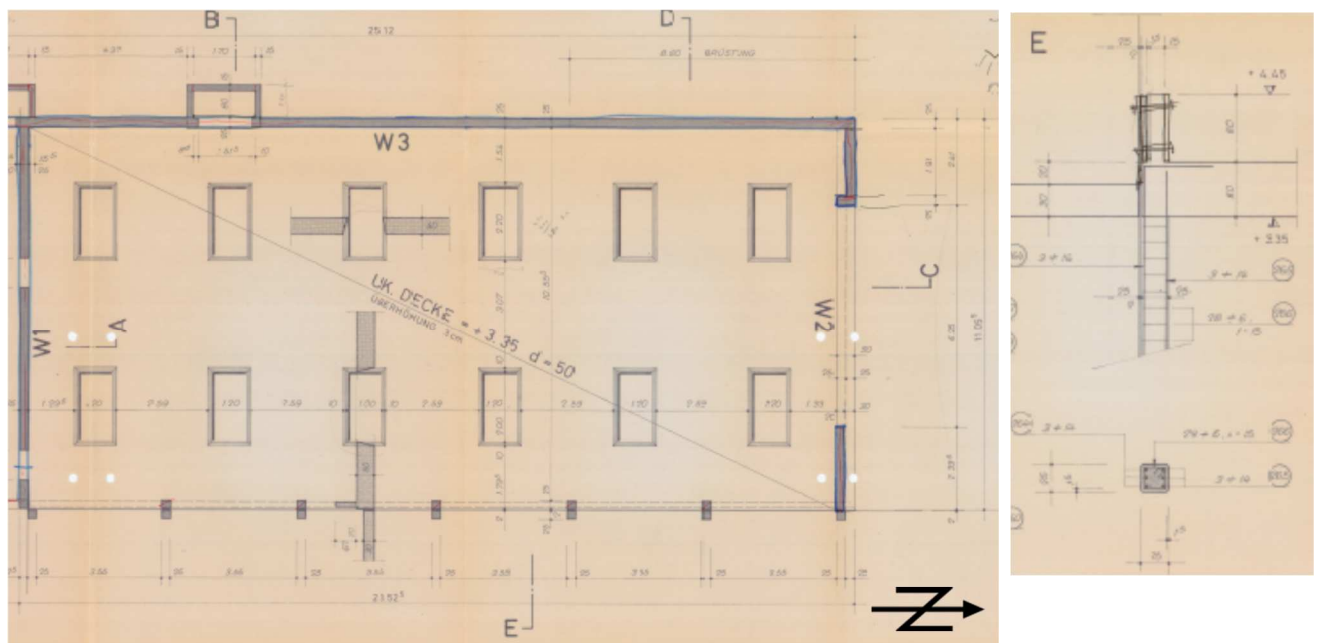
Grundriss des untersuchten Gebäudeteil 1 «Garage» (links) und Stützendetails (rechts)
